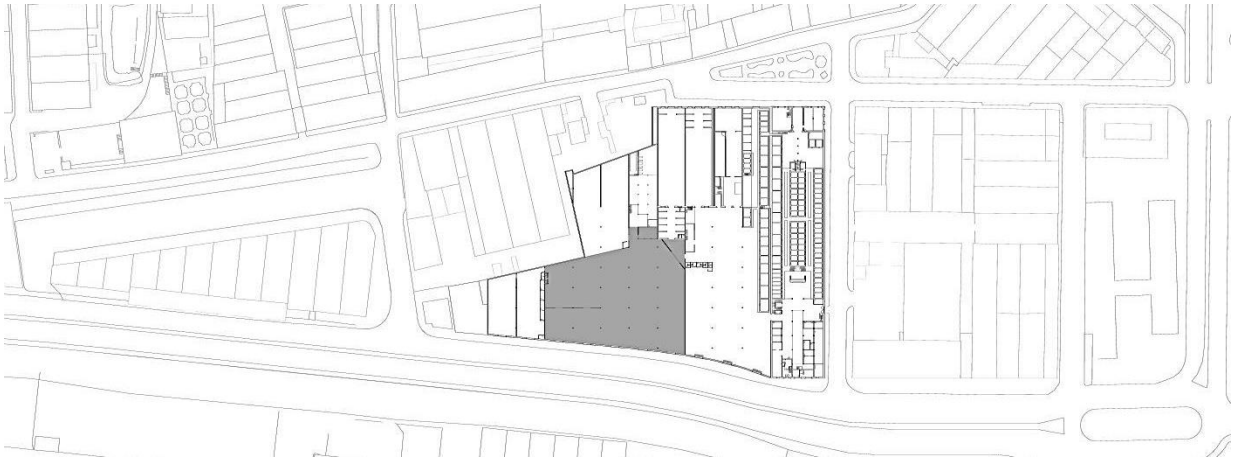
Planta de levantamento fotográfico piso térreo – Armazéns 11, 14, 16, 18 e 19.
